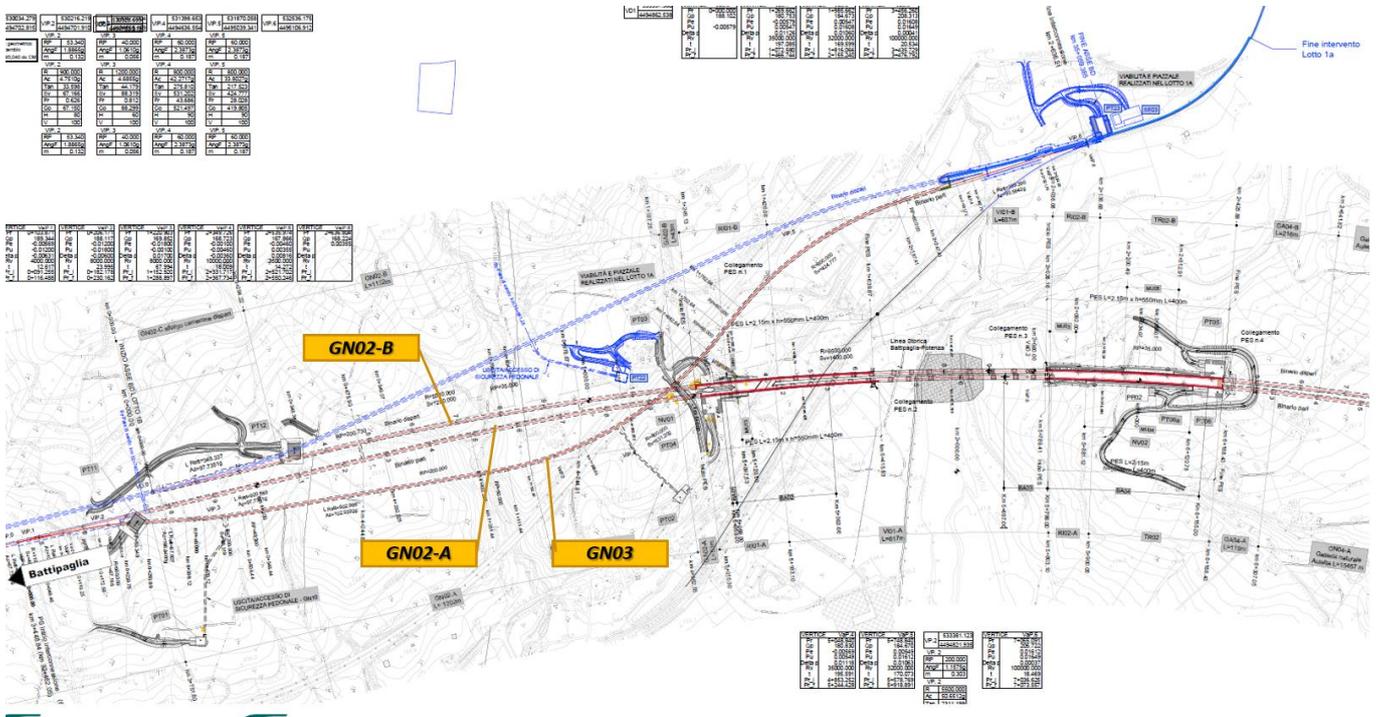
Planimetria di progetto da km 3+750 a km 6+188
